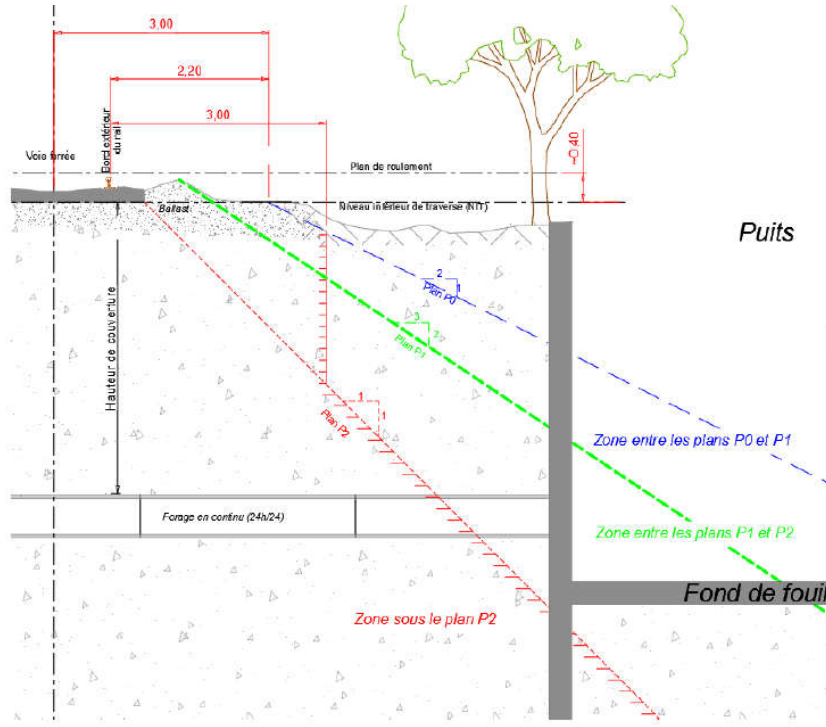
Représentation des plans de stabilité d'une voie ferrée
